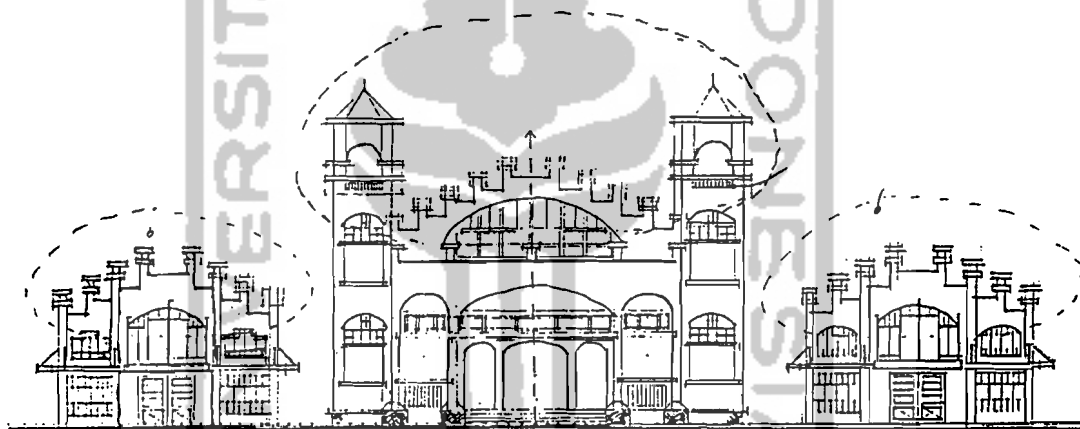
Ornament Pada Bangunan Stasiun KA
